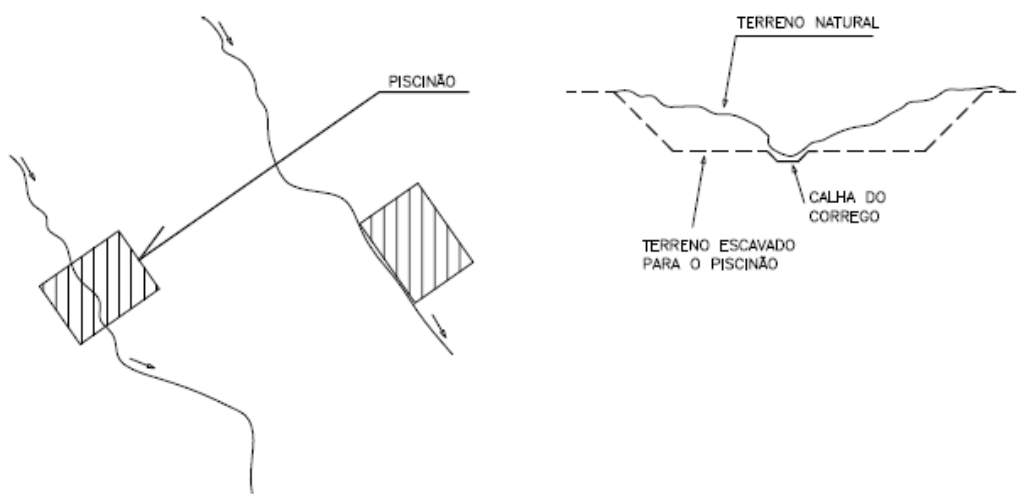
PLANTA E CORTE TÍPICO DE UM “PISCINÃO”
